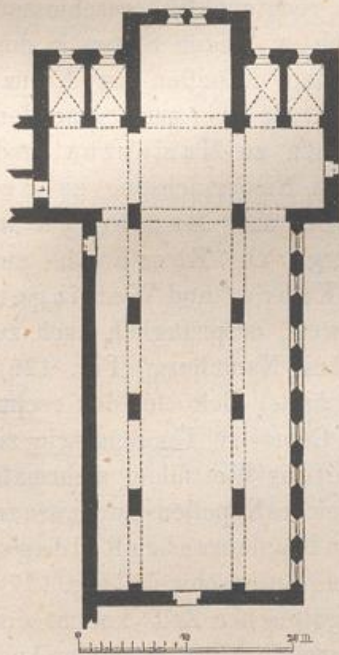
Ursprünglicher Grundriss der Kirche zu Pforta.
